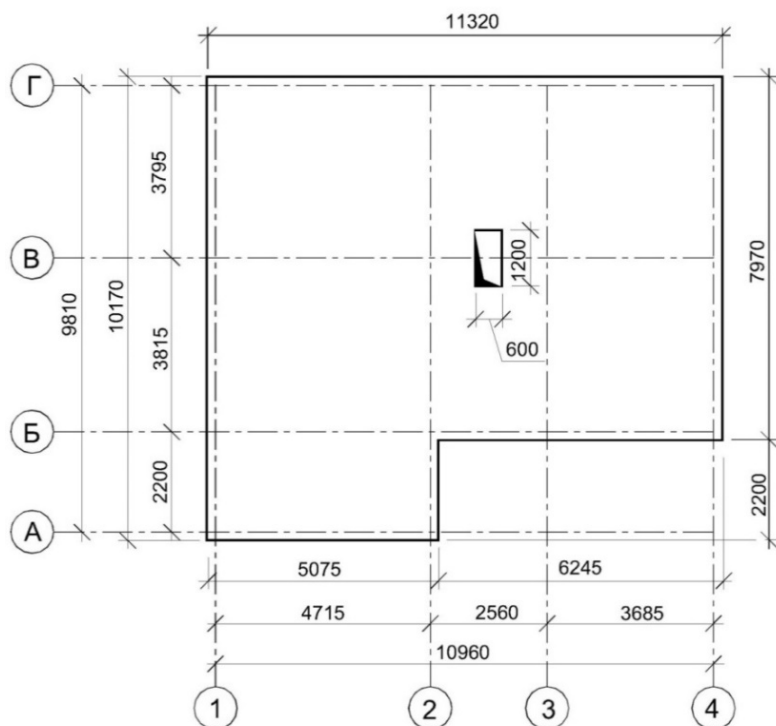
План плиты перекрытия на отметке +3,130
